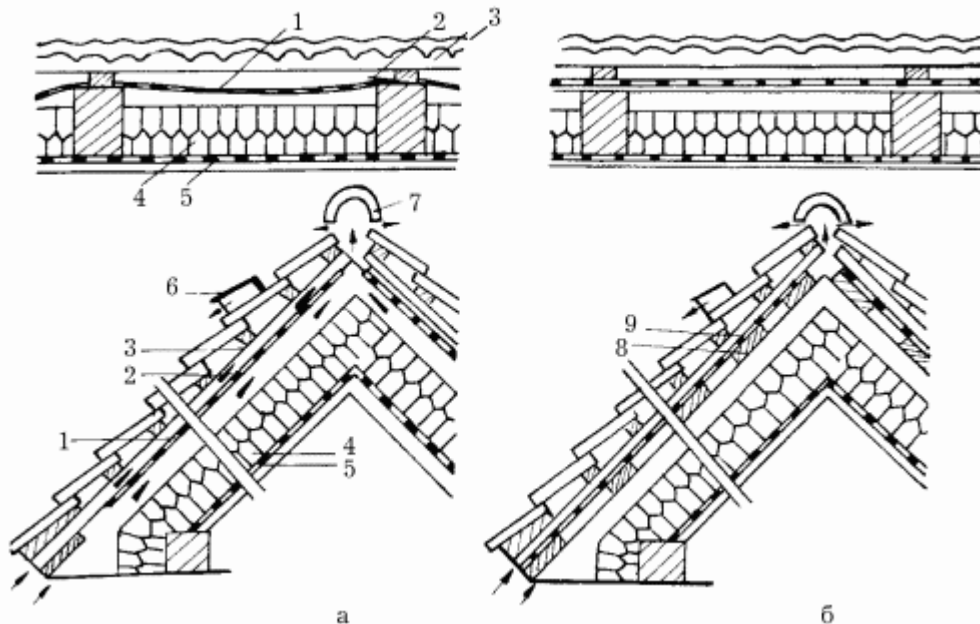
Изоляция между стропилами: а – с прокладной лентой; б – с деревянной обшивкой и защитным слоем; 1 – прокладная лента; 2 – контрбрусья; 3 – обрешетка; 4 – теплоизоляция; 5 — гидроизоляция; 6 – черепица; 7 – вентиляционный конек; 8 —деревянная обшивка; 9 – защитный слой.
